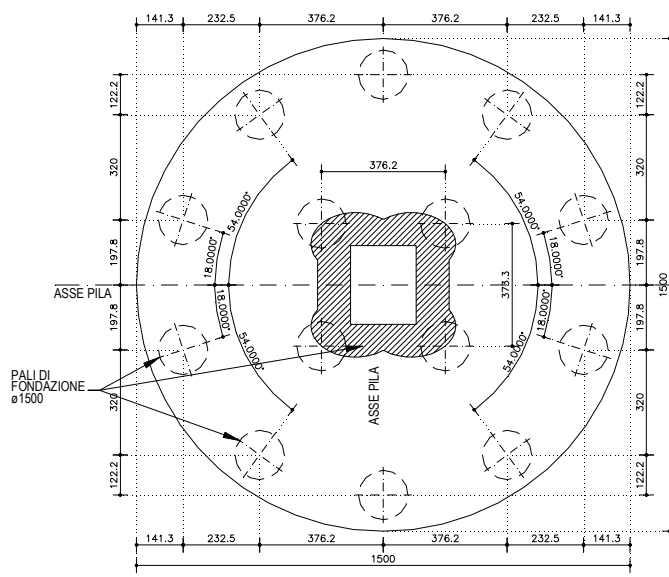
Pianta fondazione pila – Progetto Esecutivo
